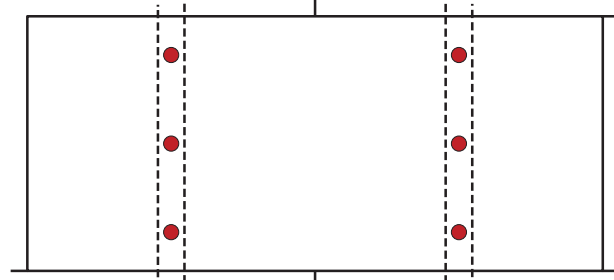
Mechanische Befestigung mittels Baumit HolzDübel Speed
